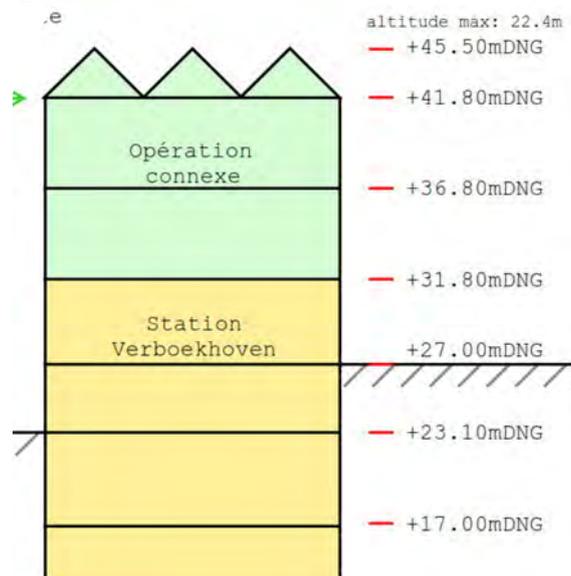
Coupe schématique de la boîte sud de la station Verboekhoven et de l'équipement en sur-construction (BMN, 2020)
